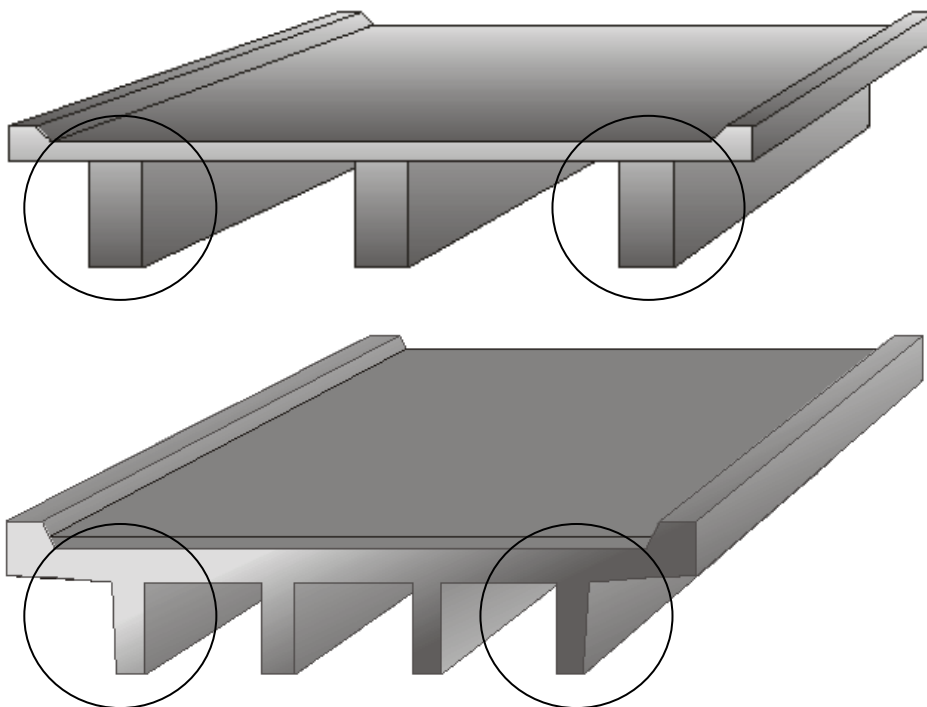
Posizione dell'Elemento Standard nella struttura (BRIME – D14).
